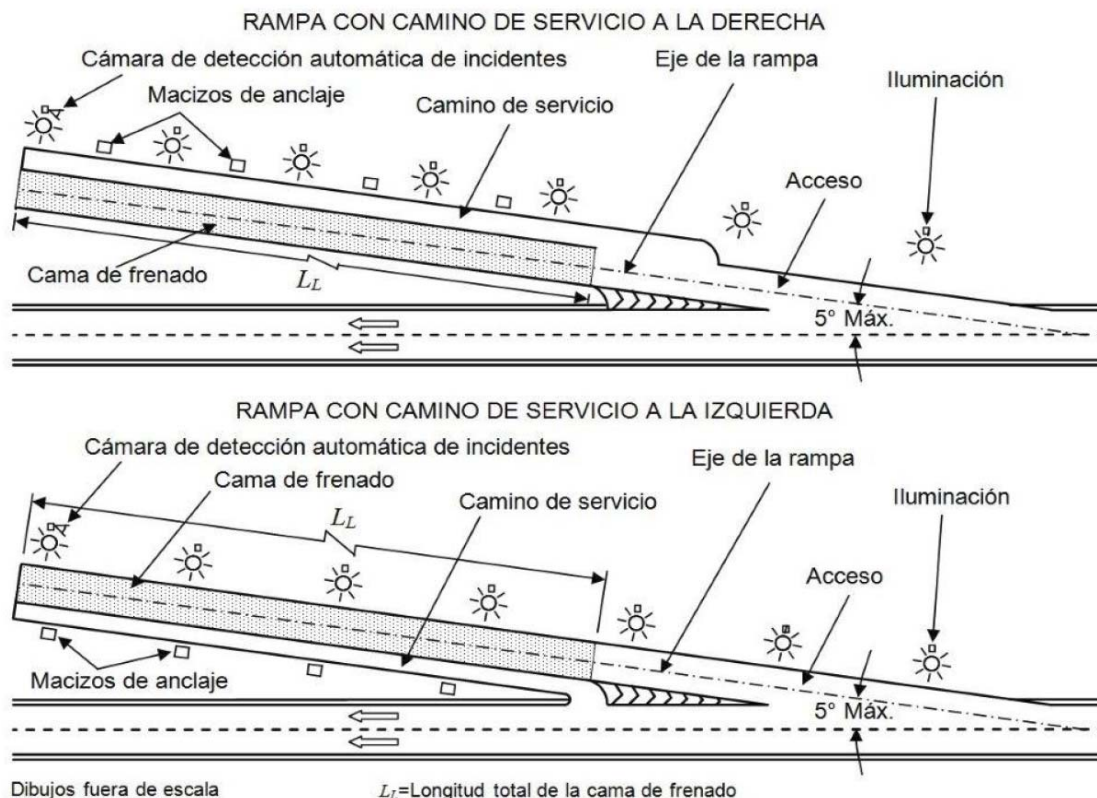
Rampa de emergencia para frenado. Esquema de disposición en planta
